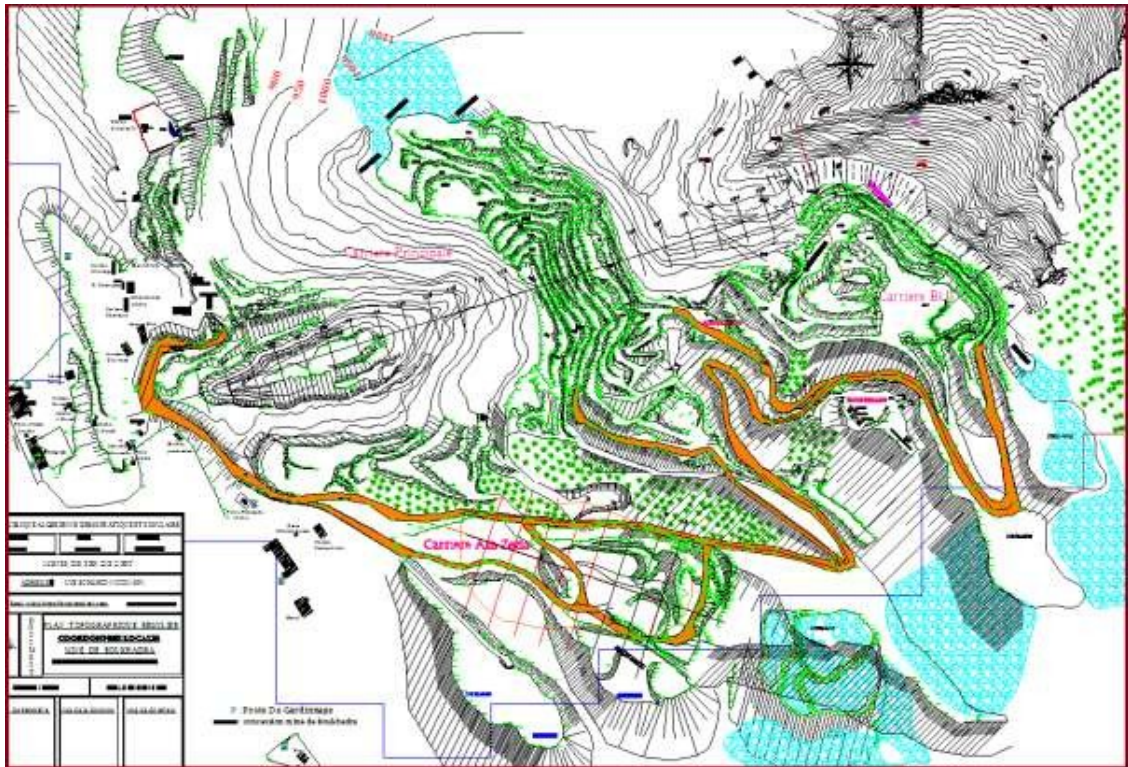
Plan d'ouverture de la mine de Boukhadra
